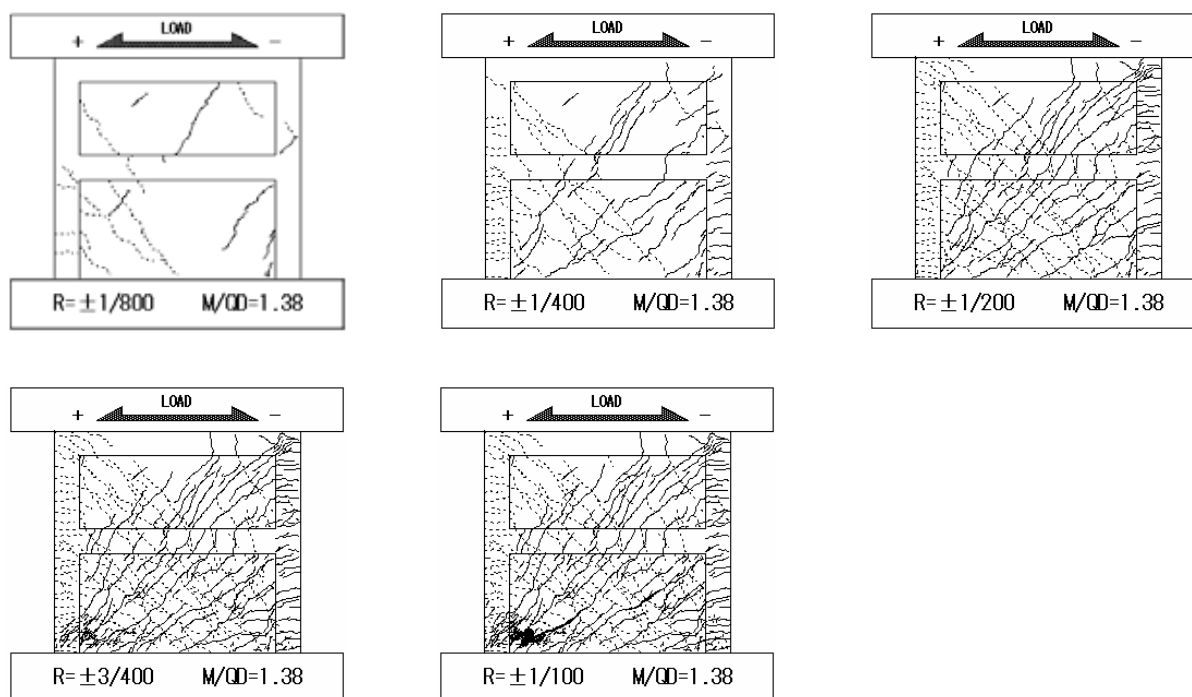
各部材各の終了時におけるひび割れ状況(試験体 A)
